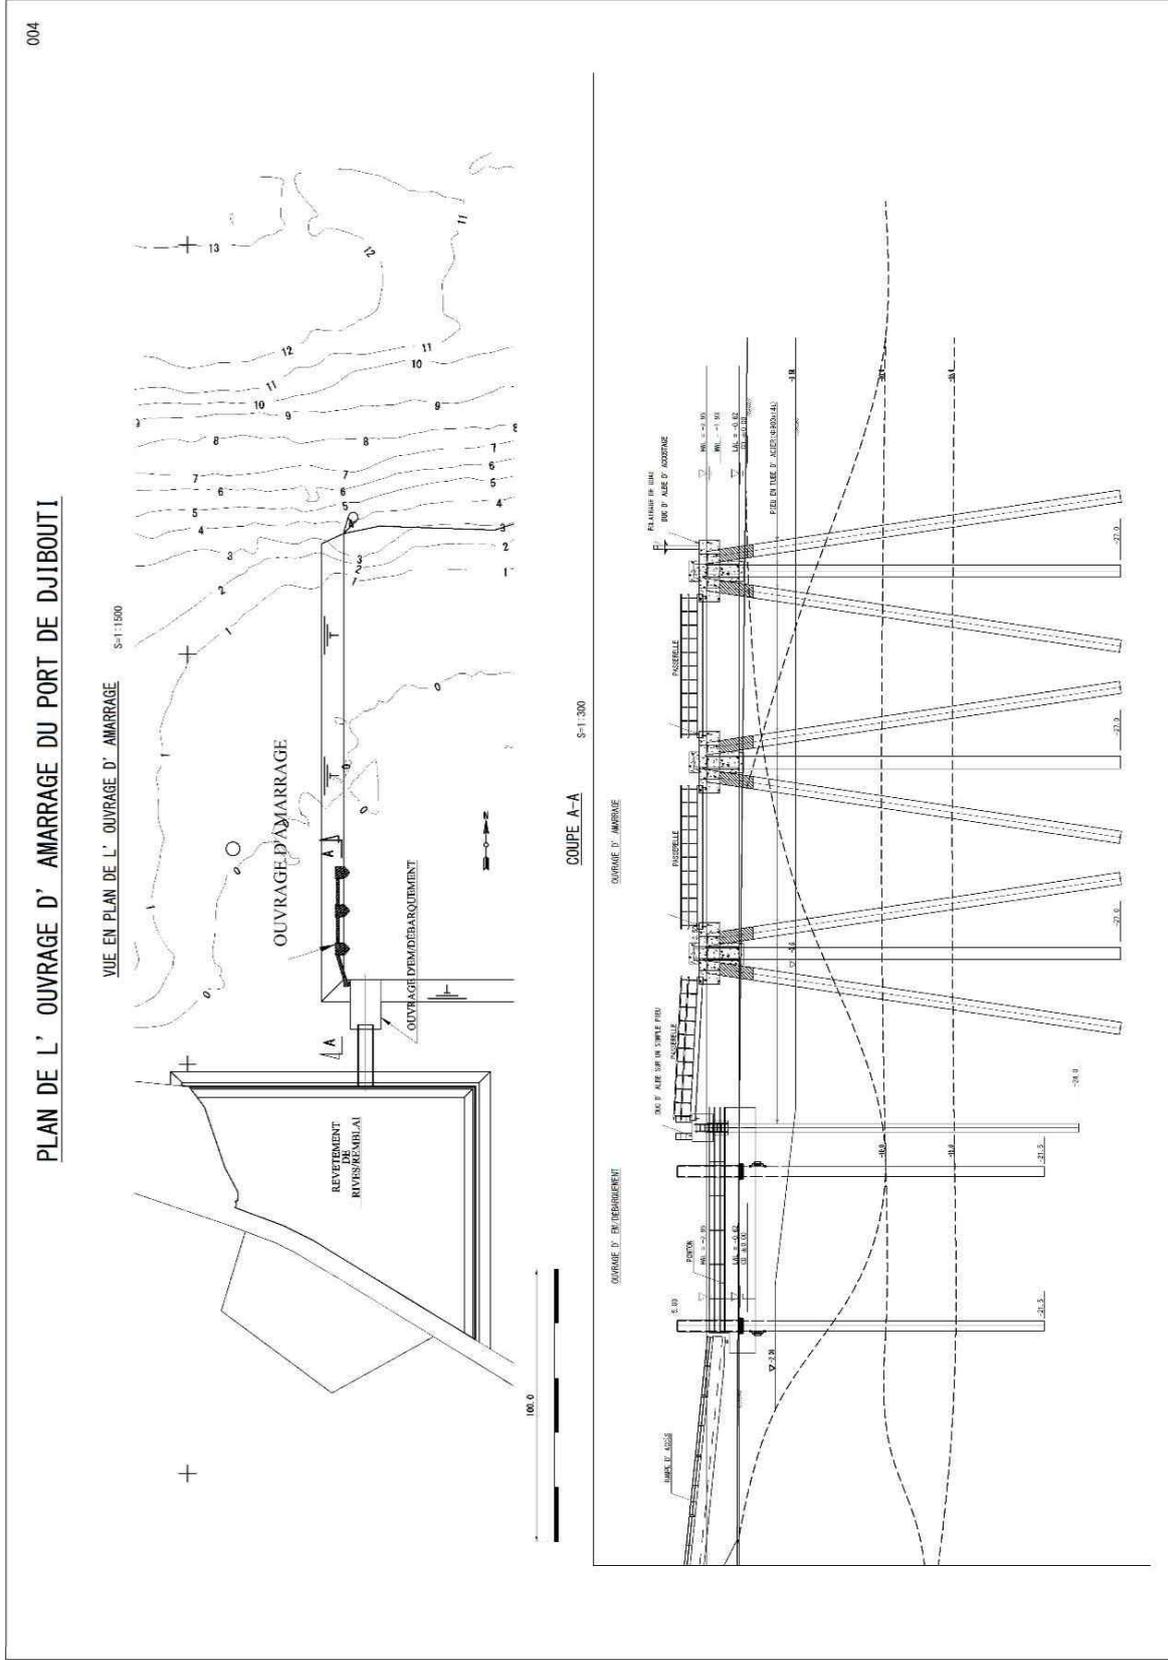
Plan de l'ouvrage d'amarrage du Port de Djibouti
